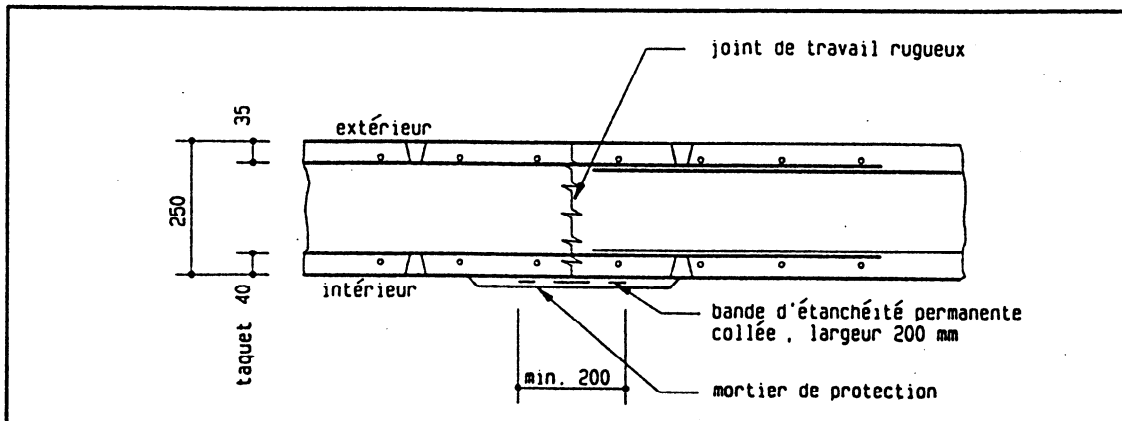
Etapes du bétonnage, bande d'étanchéité collée
